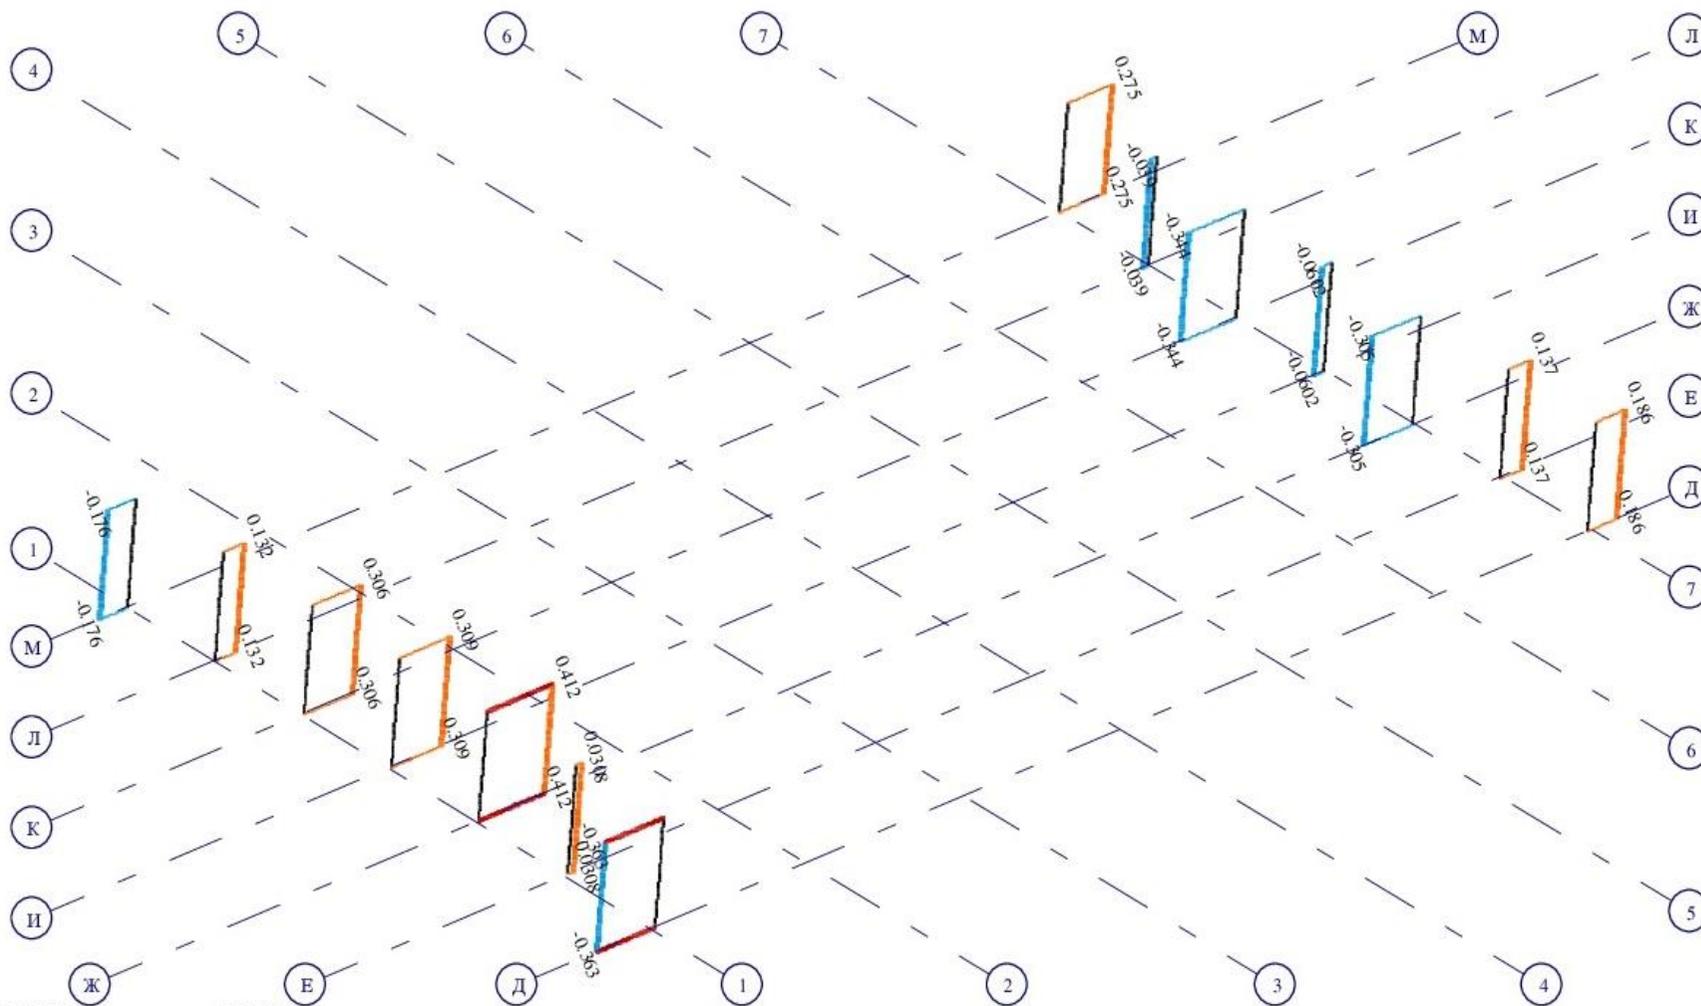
Схема нагрузок Qy на фундаменты манеж
